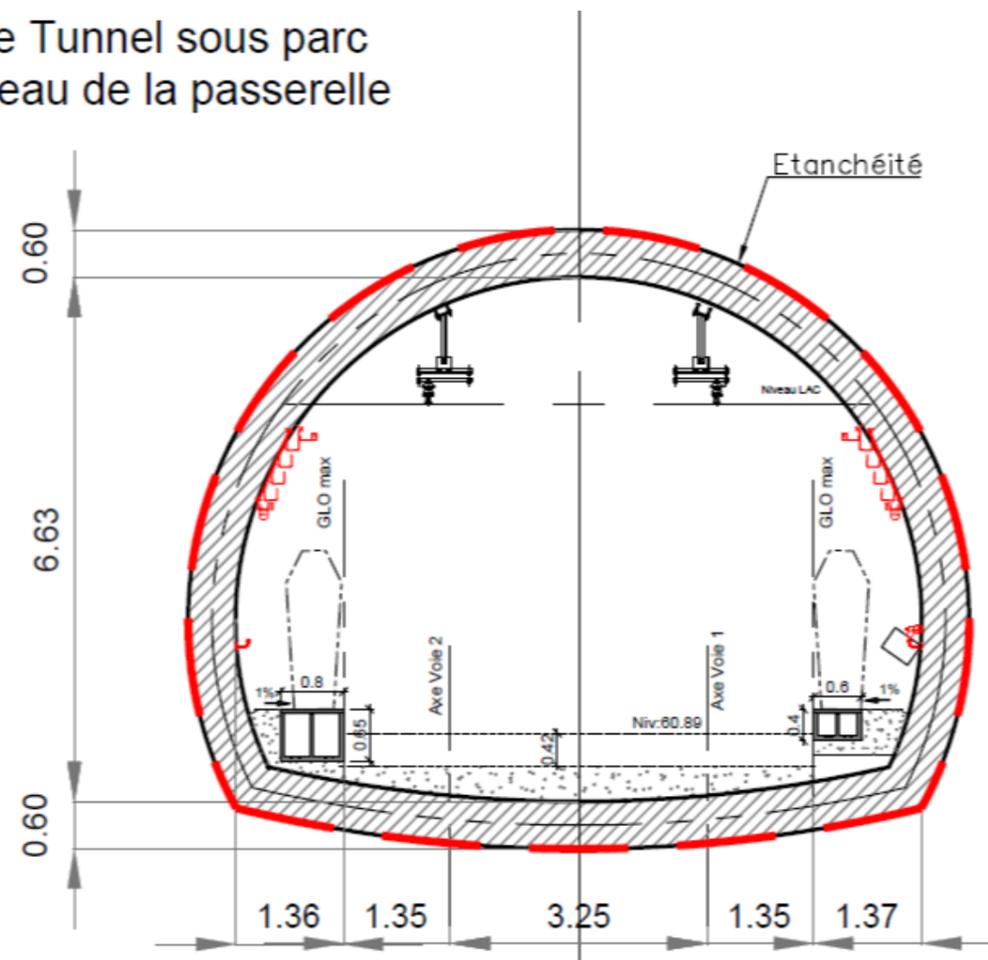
Coupe de principe du tunnel sous le Parc de la Mairie de Juvisy-sur-Orge
